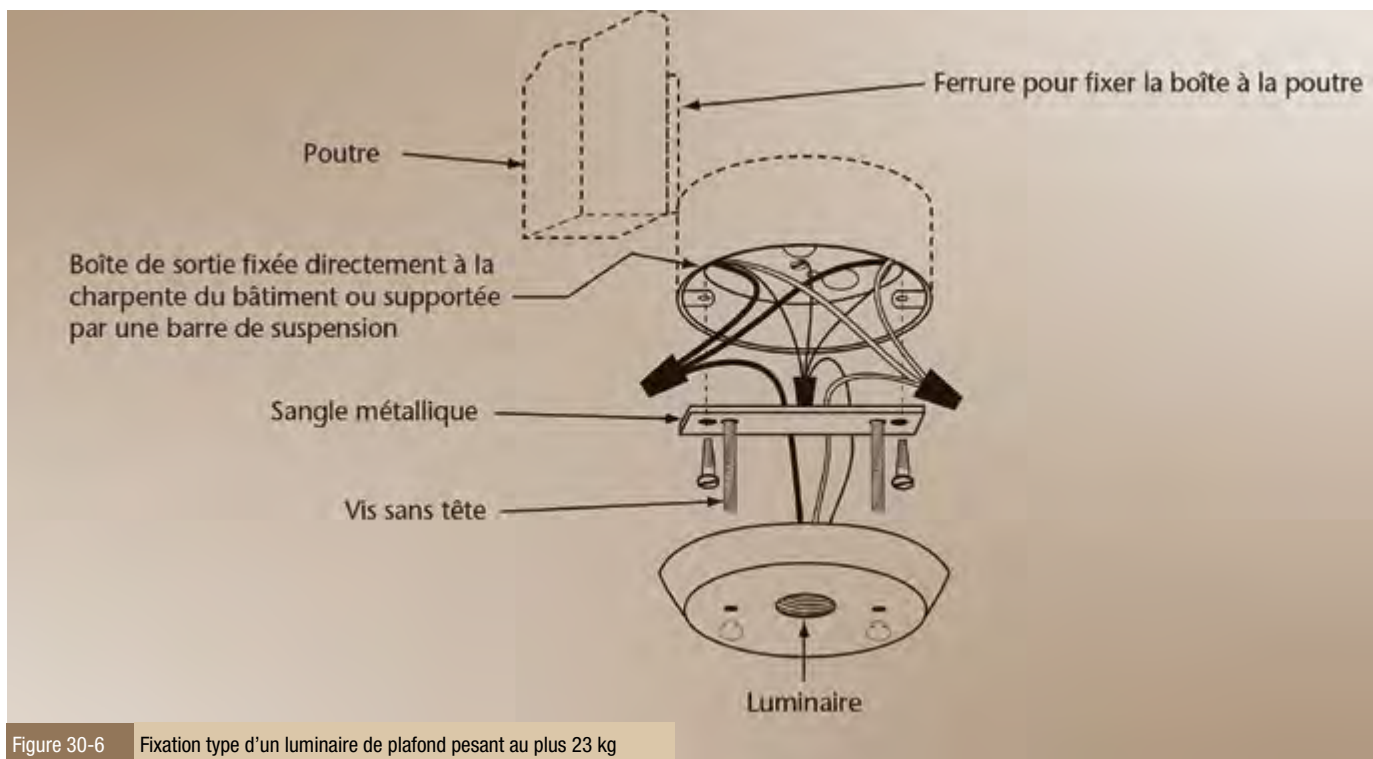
Fixation type d'un luminaire de plafond pesant au plus 23 kg
